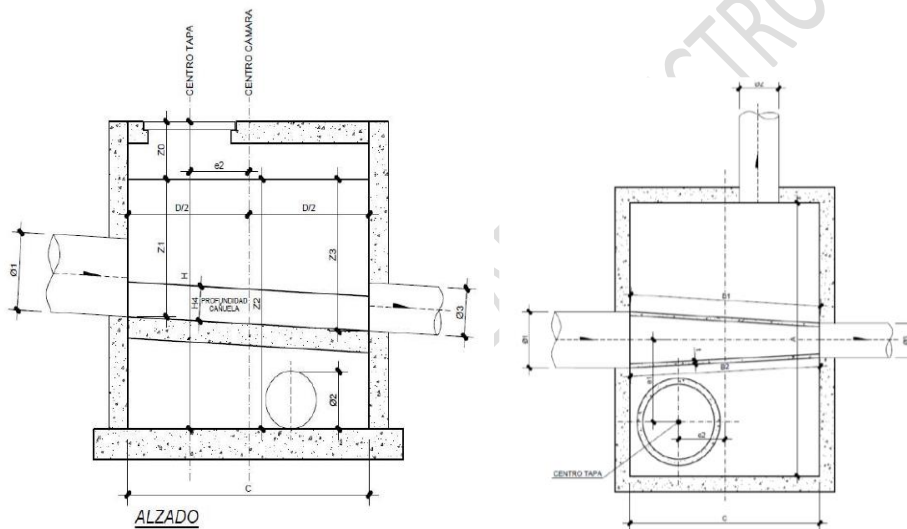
Vista en altura y planta del levantamiento de un aliviadero de cañuela elevada en caja.
